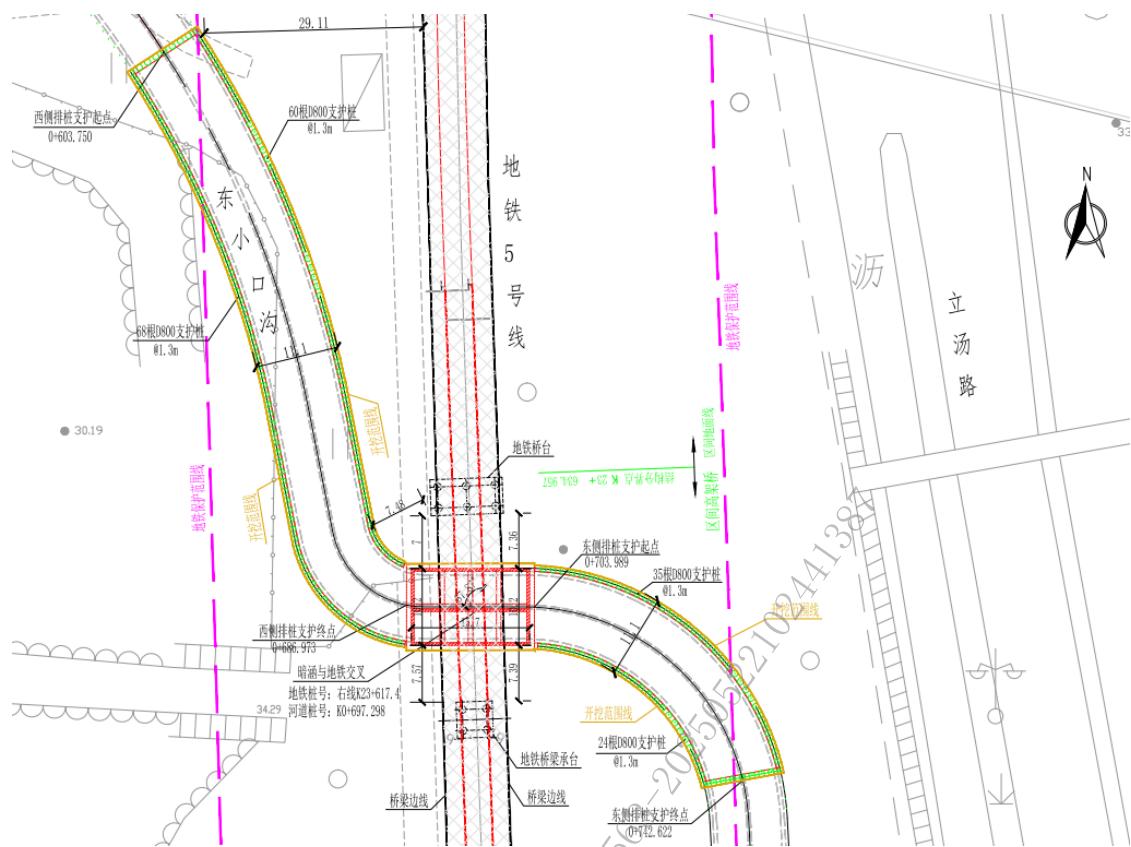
地铁 5 号线桥梁投影外, 保护区范围内排桩基坑支护平面图
